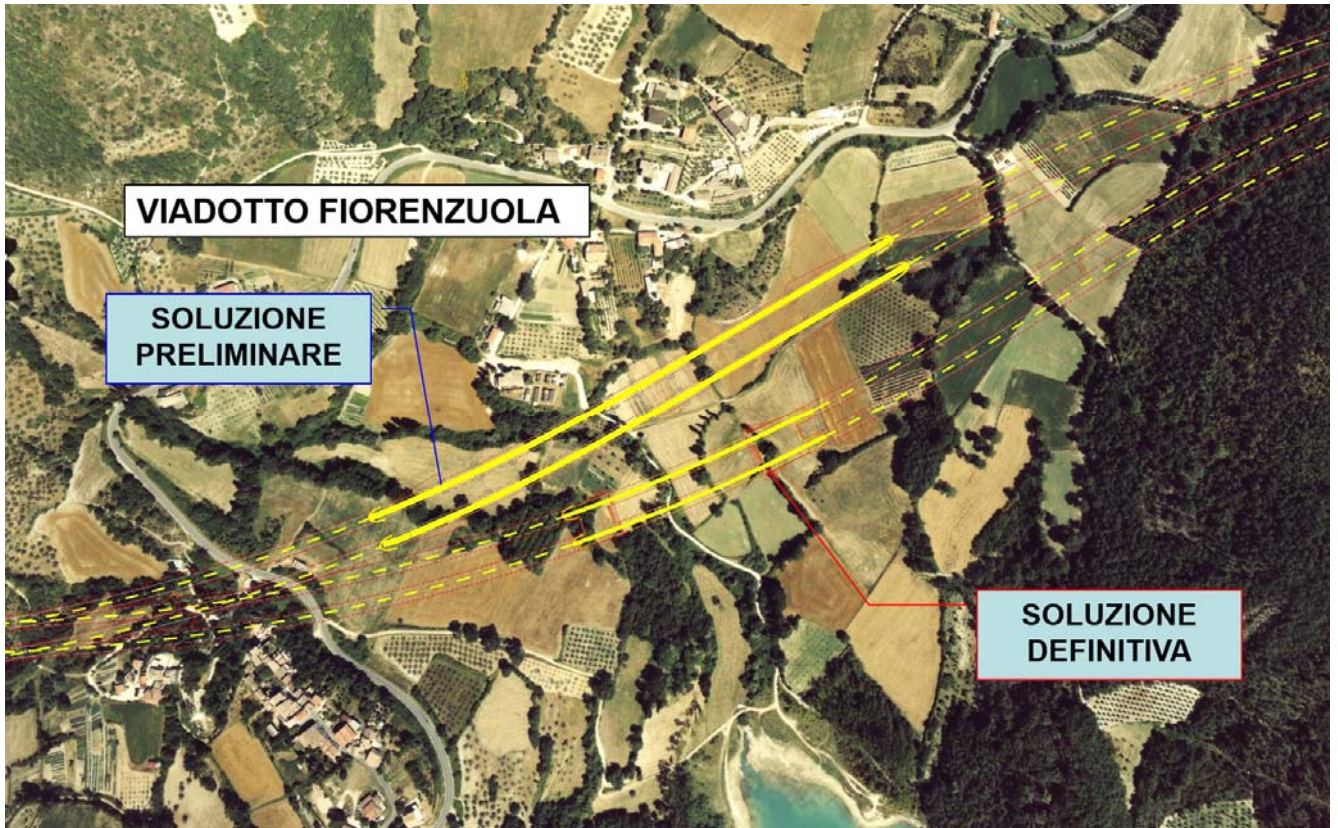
Planimetria sovrapposizione PP2005 e aggiornamento CIPE
